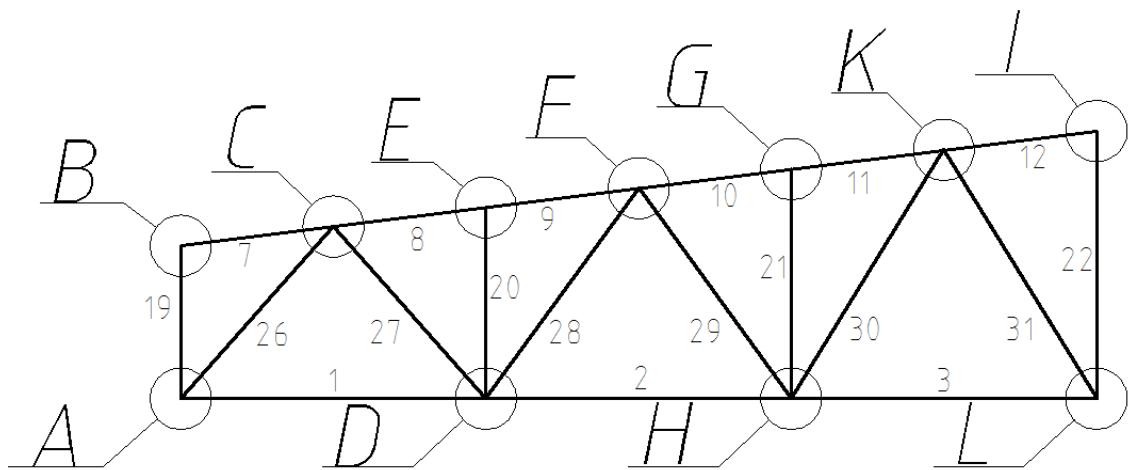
Маркировка узлов на геометрической схеме фермы.
